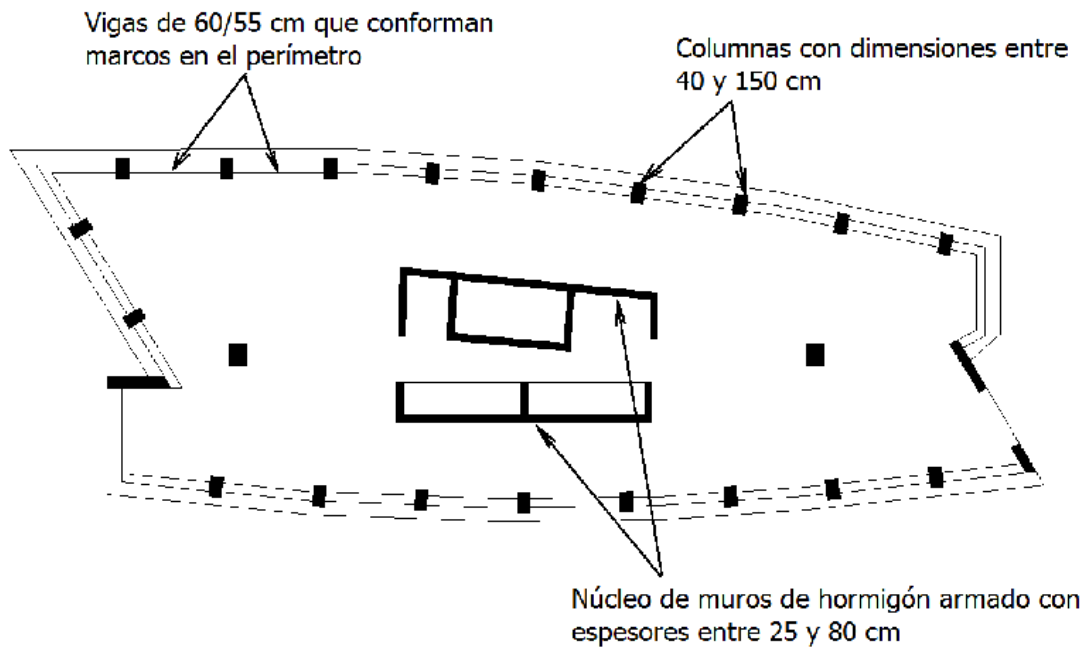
Vista en planta del piso tipo del edificio Parque Araucano.
